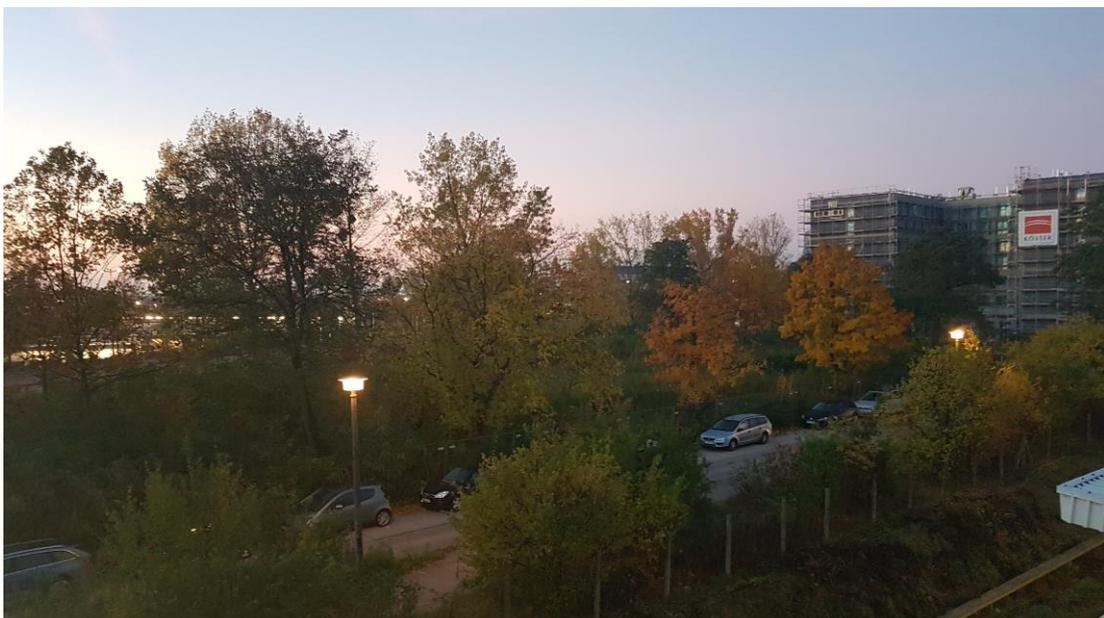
betroffenes Grundstück- Nordansicht Schwalbenstraße (aus [4])
